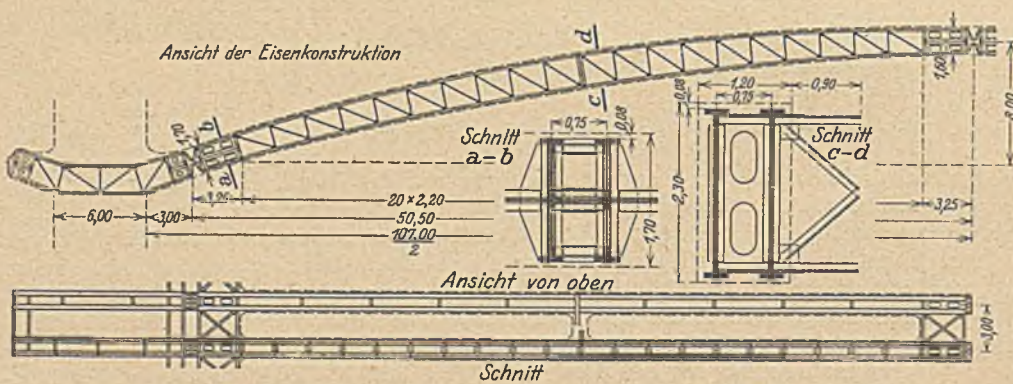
Entwurf Hüser & Cie., steife Bewehrung der Hauptöffnungen.
